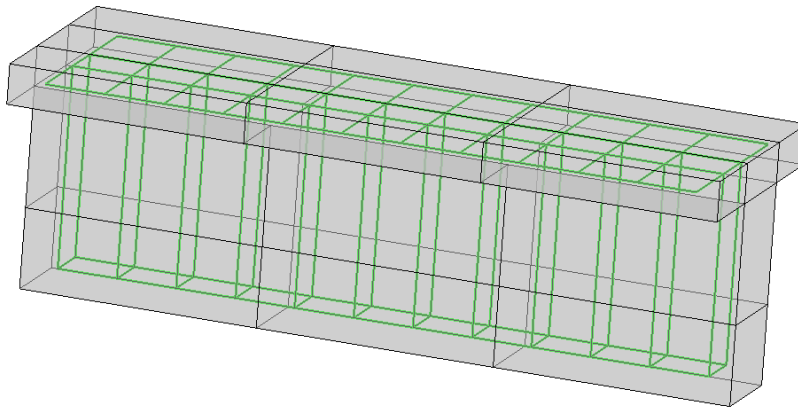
Malha dos elementos de armadura passiva para a viga.
